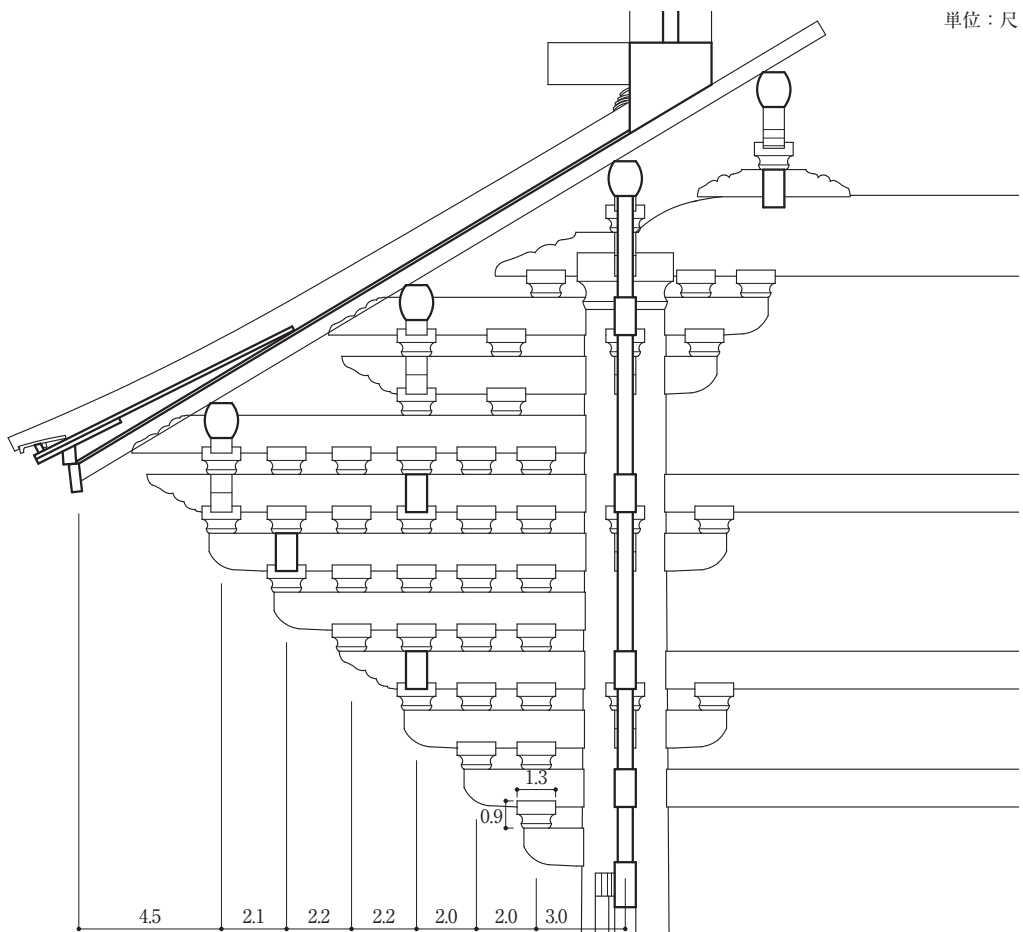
重源案 組物断面詳細図 1 : 75
